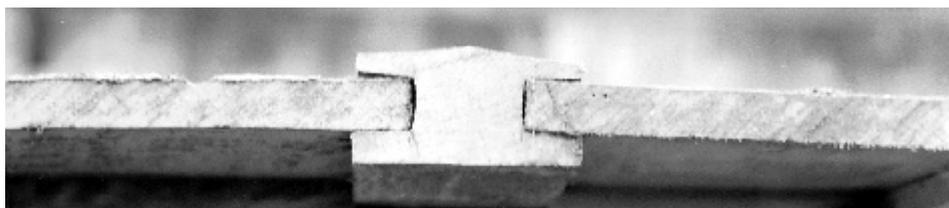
Detalhe do sistema construtivo em madeira serrada
